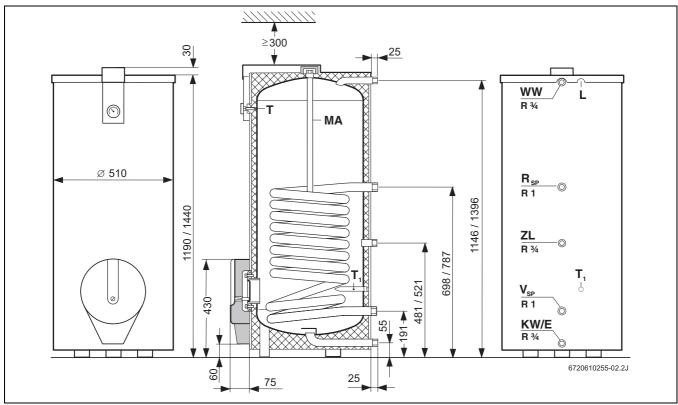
Bau- und Anschlussmaße SK 160/200-4 ZB
